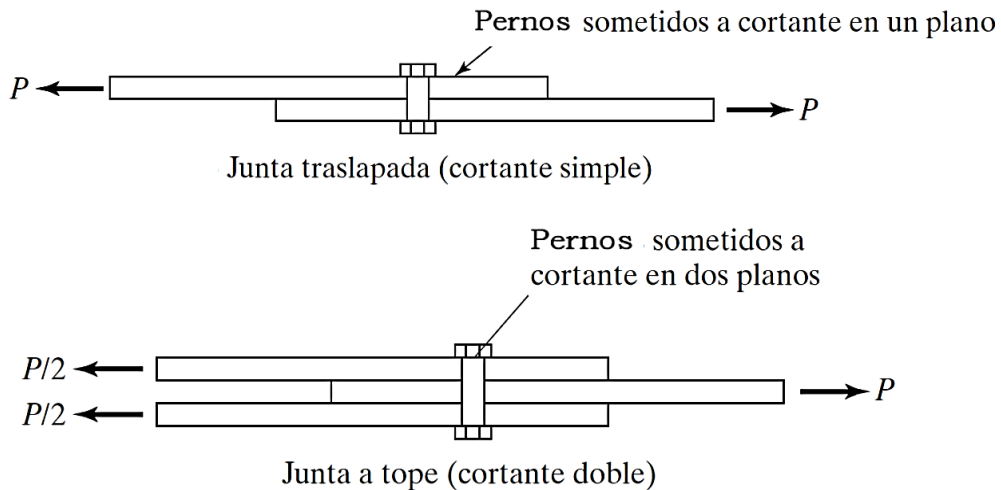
Junta traslapada y junta a tope en conexiones empernadas
